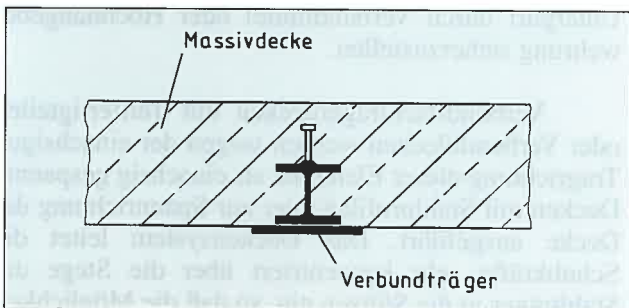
Verbundflachträgerdecken in Ortbetonbauweise
